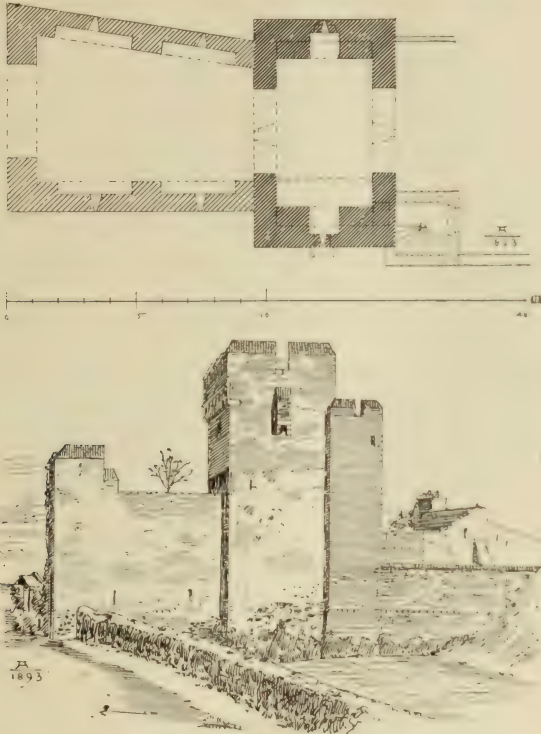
Zulpich. Grundriss und Ansicht des Kolnithores.
